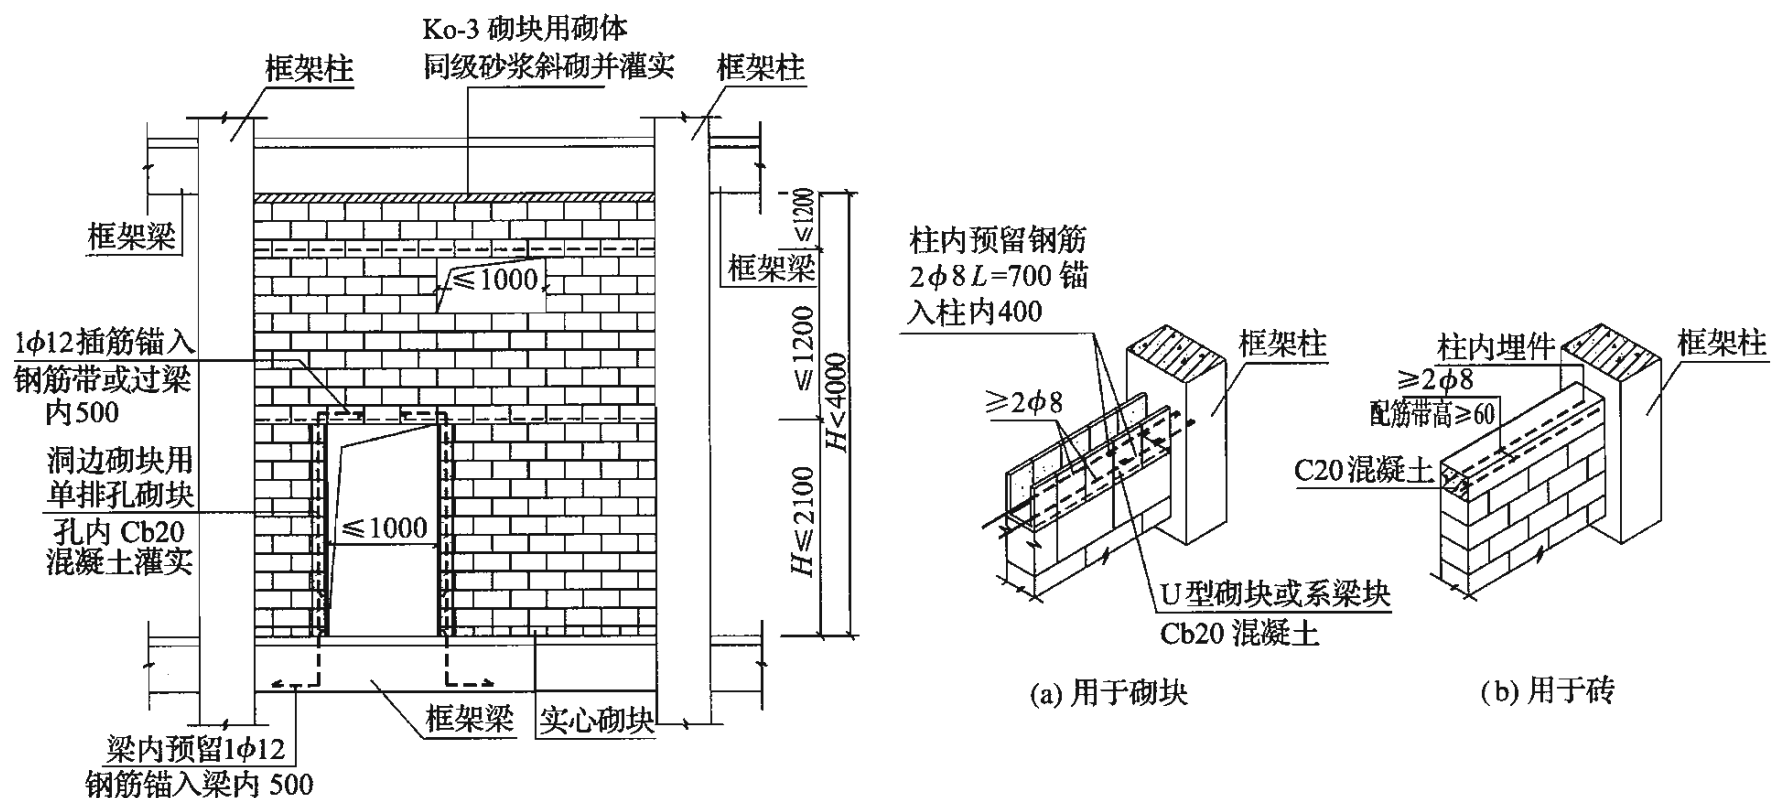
带洞口填充拉结钢筋布置示例
